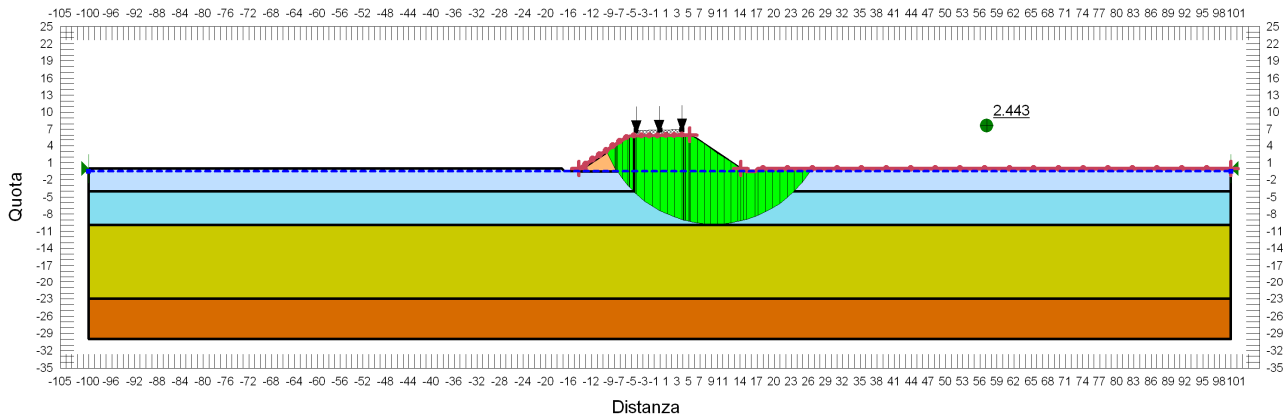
VERIFICA DI STABILITÀ GLOBALE RILEVATO DI H=6.00 M - CONDIZIONE STATICA NON DRENATA.
